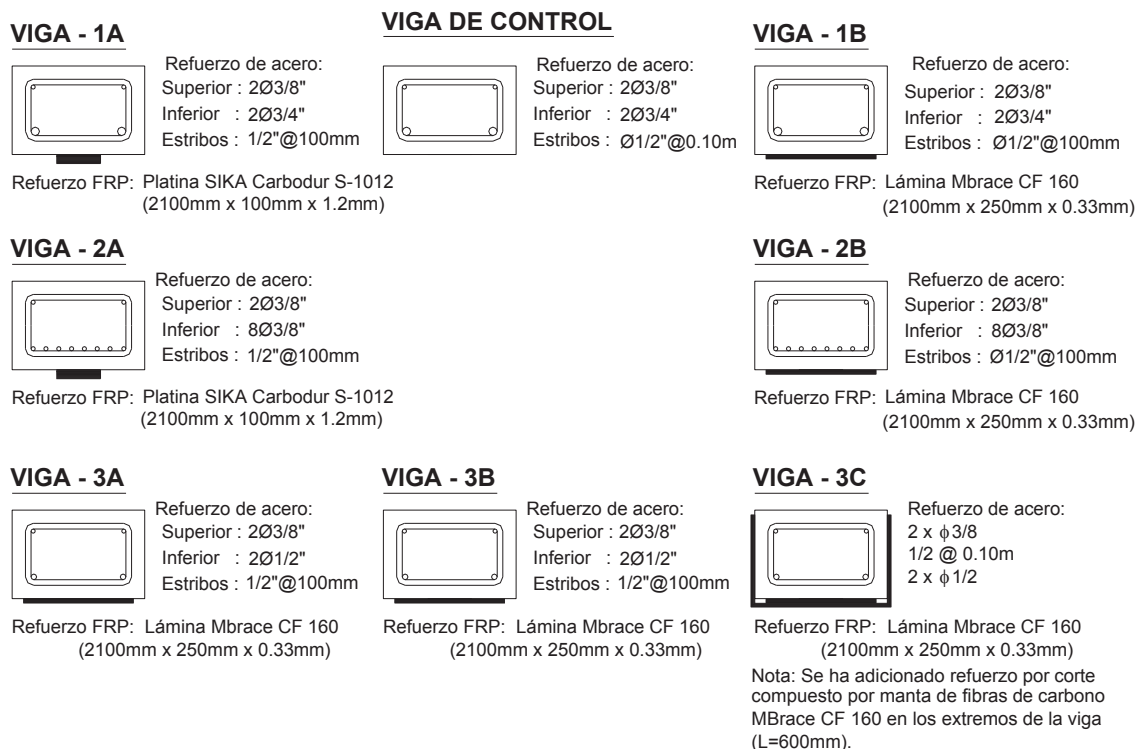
Secciones de viga a ser ensayadas a flexión con diferente refuerzo interno de acero y refuerzo externo con FRP
